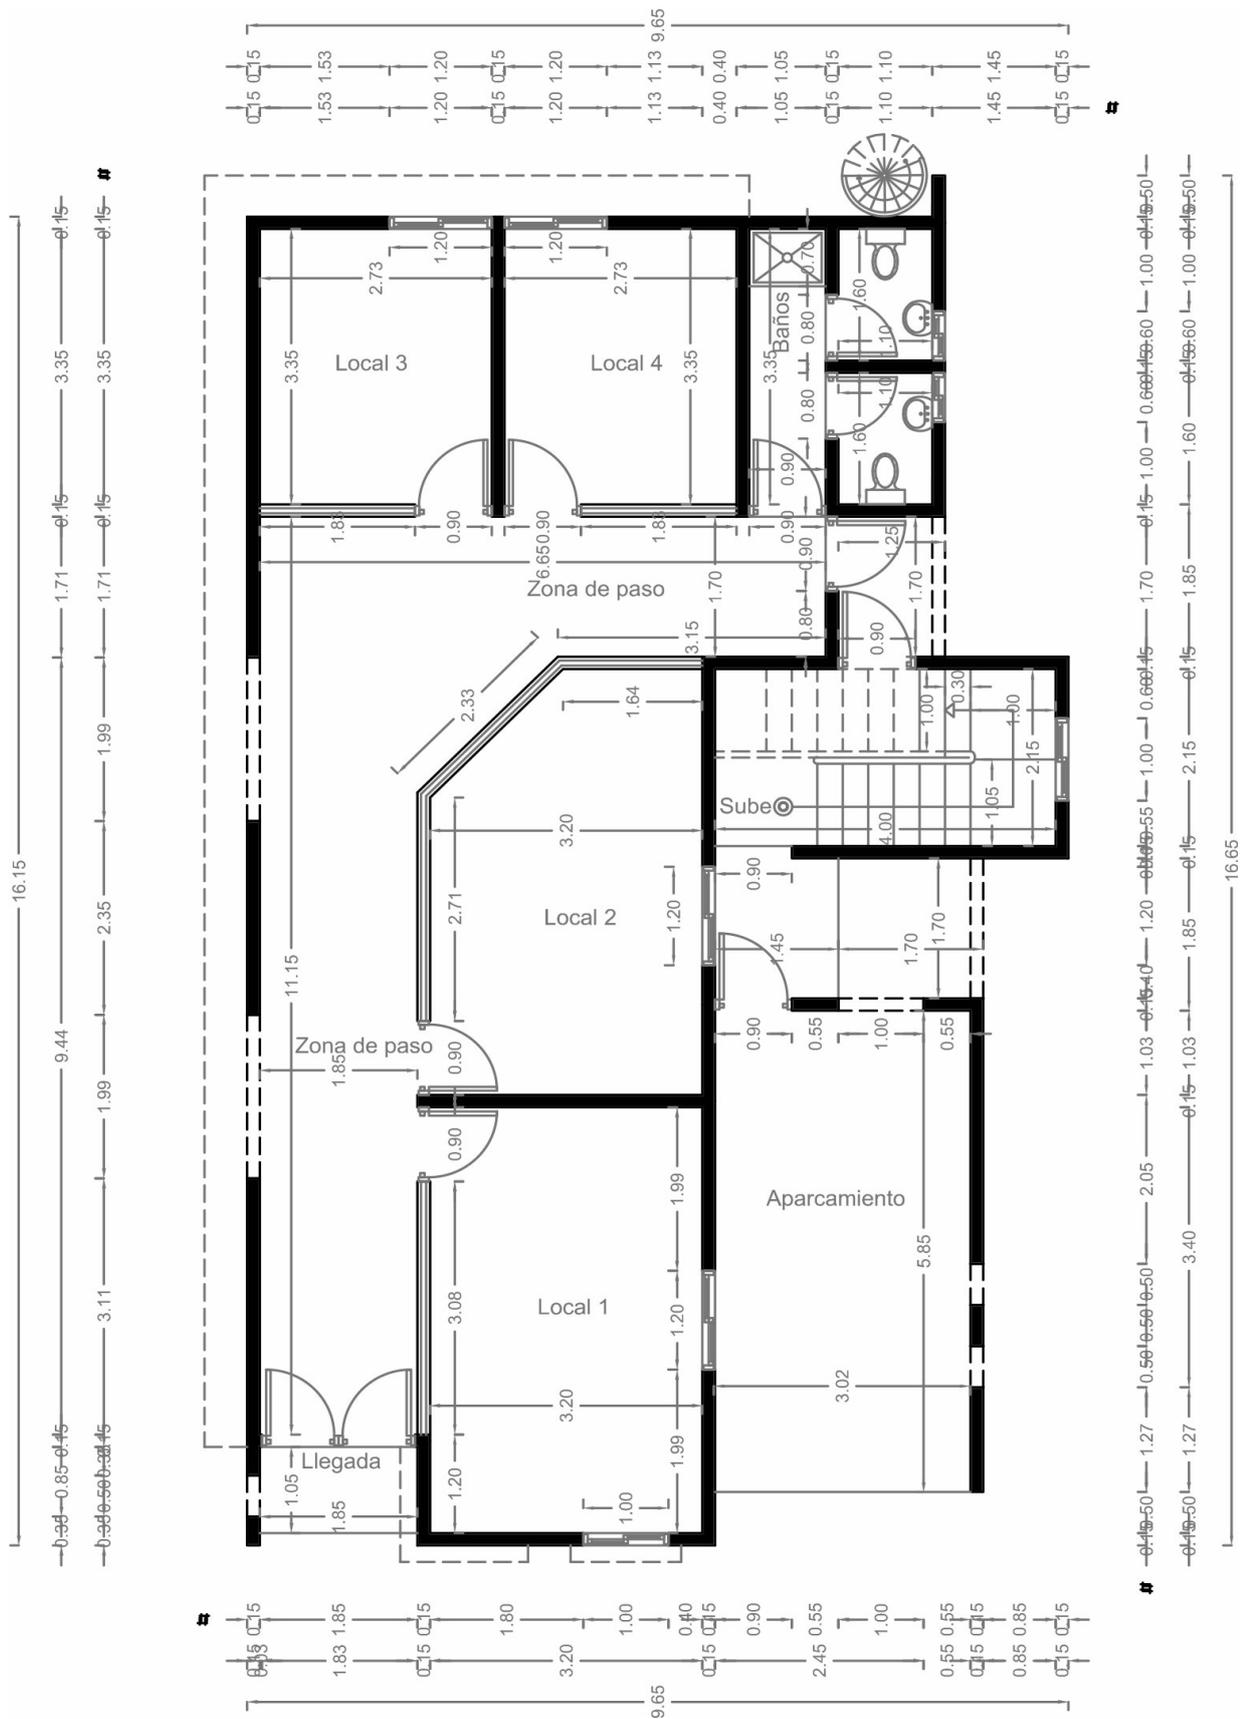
PLANTA ARQ. DIMENSIONADA (PLANTA BAJA)
